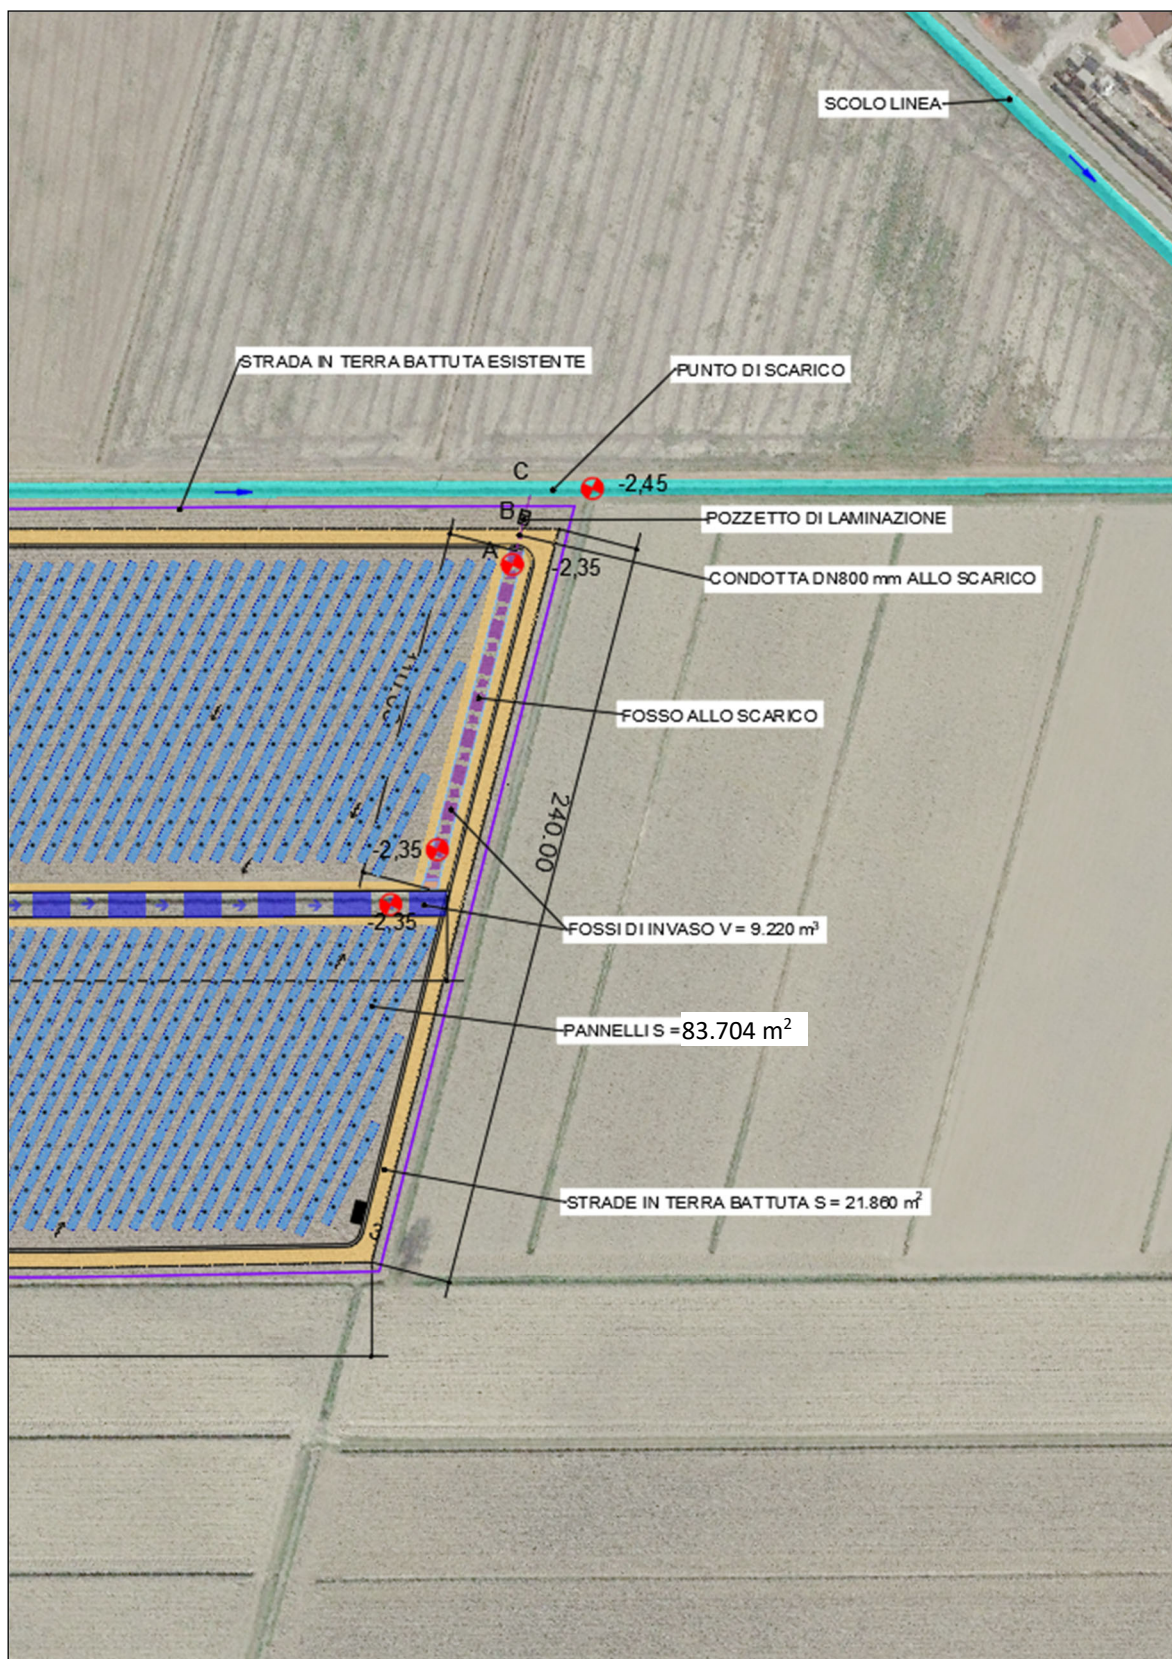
Planimetria con indicazione dei dispositivi di drenaggio e smaltimento acque meteoriche
